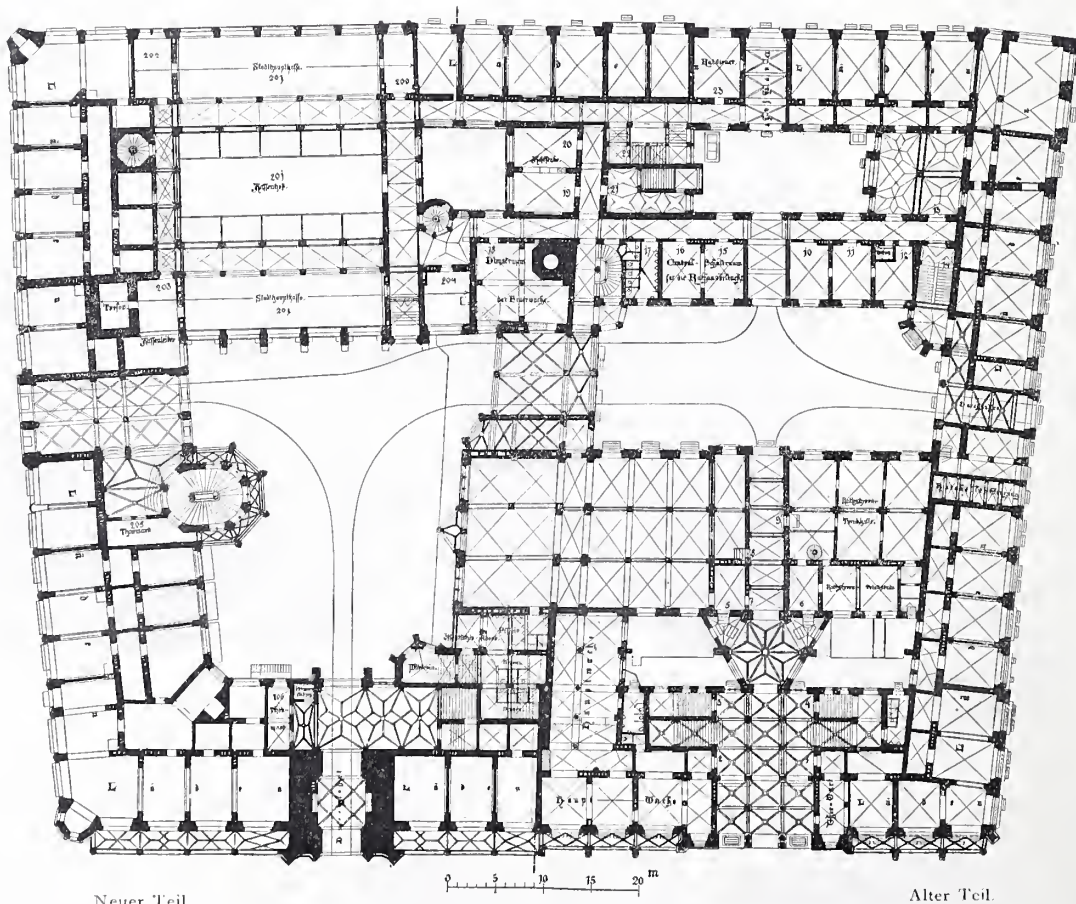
Grundriss vom Erdgeschoss. — Masstab 1 : 500.
